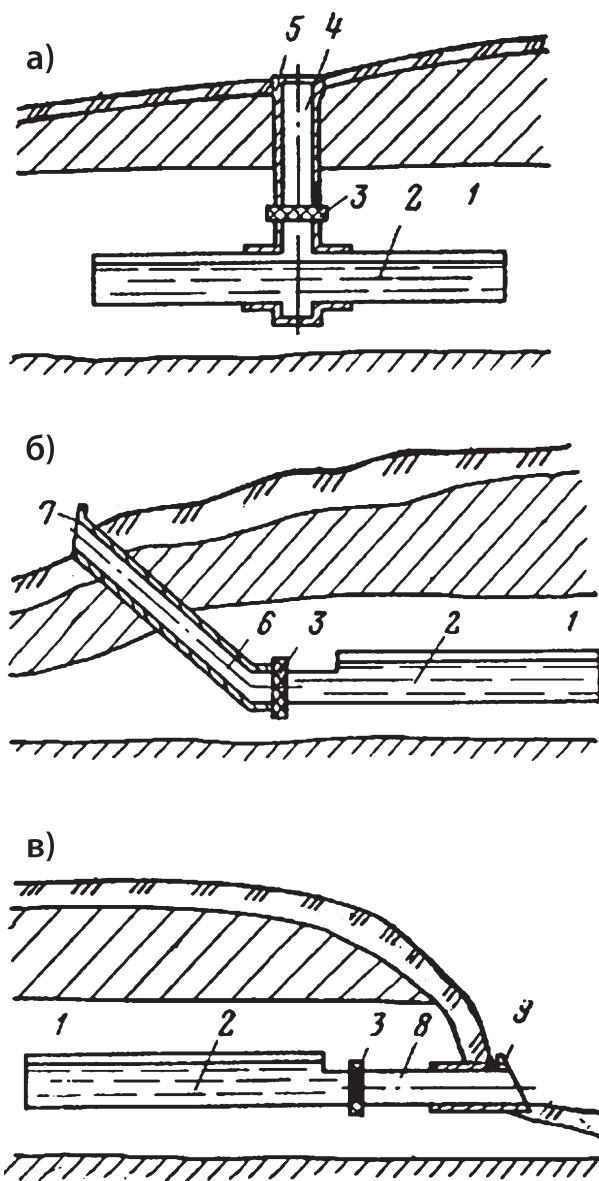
Схемы шахтных хранилищ с вертикальной (а), наклонной (б) и горизонтальной (в) вскрывающими выработками:
